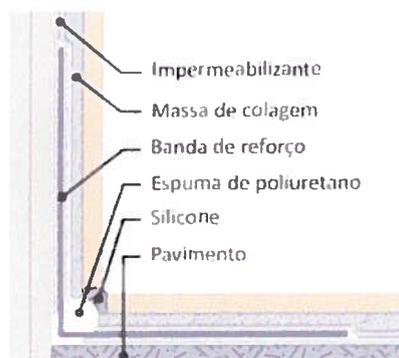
Reforço do sistema de impermeabilização no perímetro inferior do compartimento e cantos ou encontros verticais.
